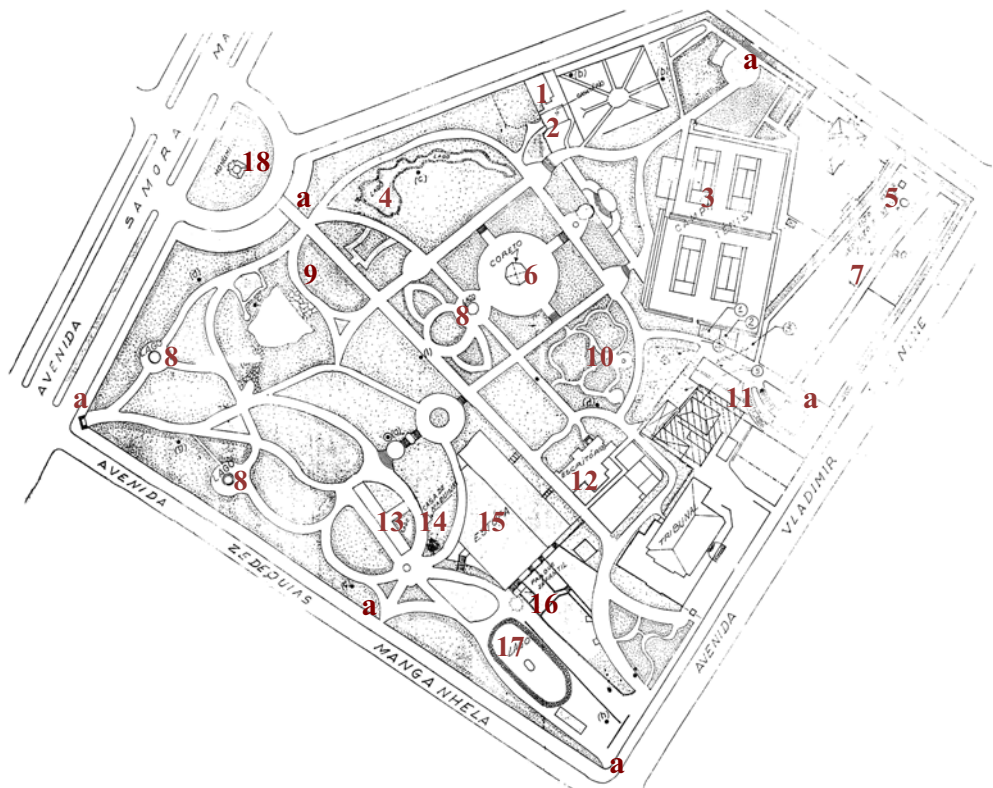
Planta do Jardim Tunduru, 1998, CEDH-FAPF. Legenda: Casa do Jardineiro (1); Sanitários (2); Campos de ténis (3); Lago (4) (foi esvaziado e só resta o fosso); Depósito elevado de
